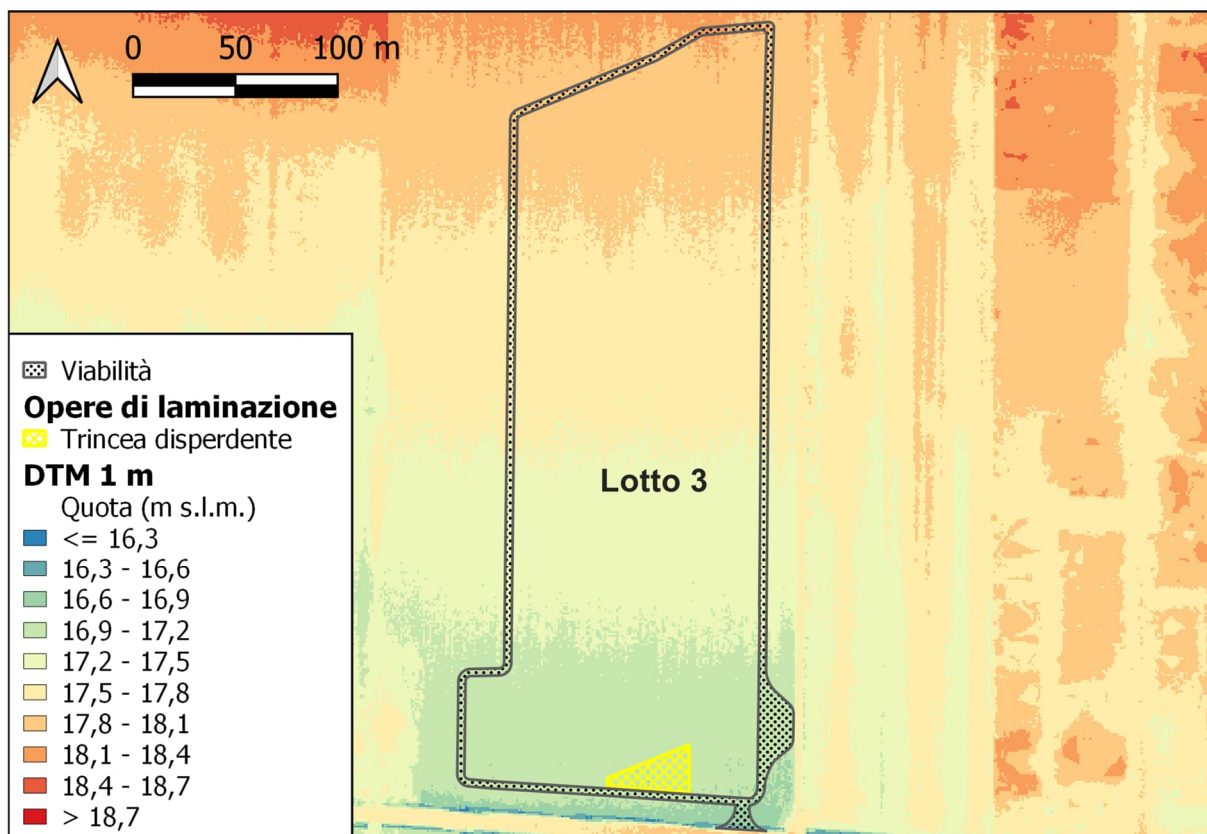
Posizionamento planimetrico delle opere di laminazione nel lotto 3.
